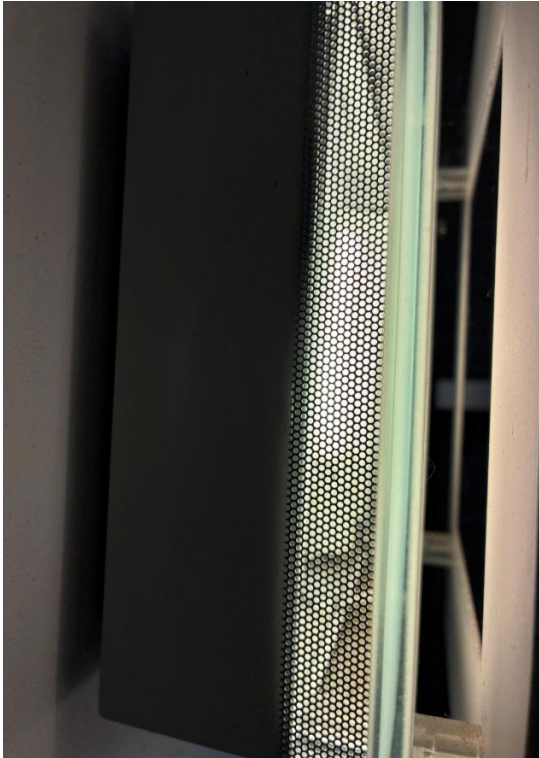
Detailfoto 2 van toegepast wandarmatuur entree Aula begraafplaats Sprang
